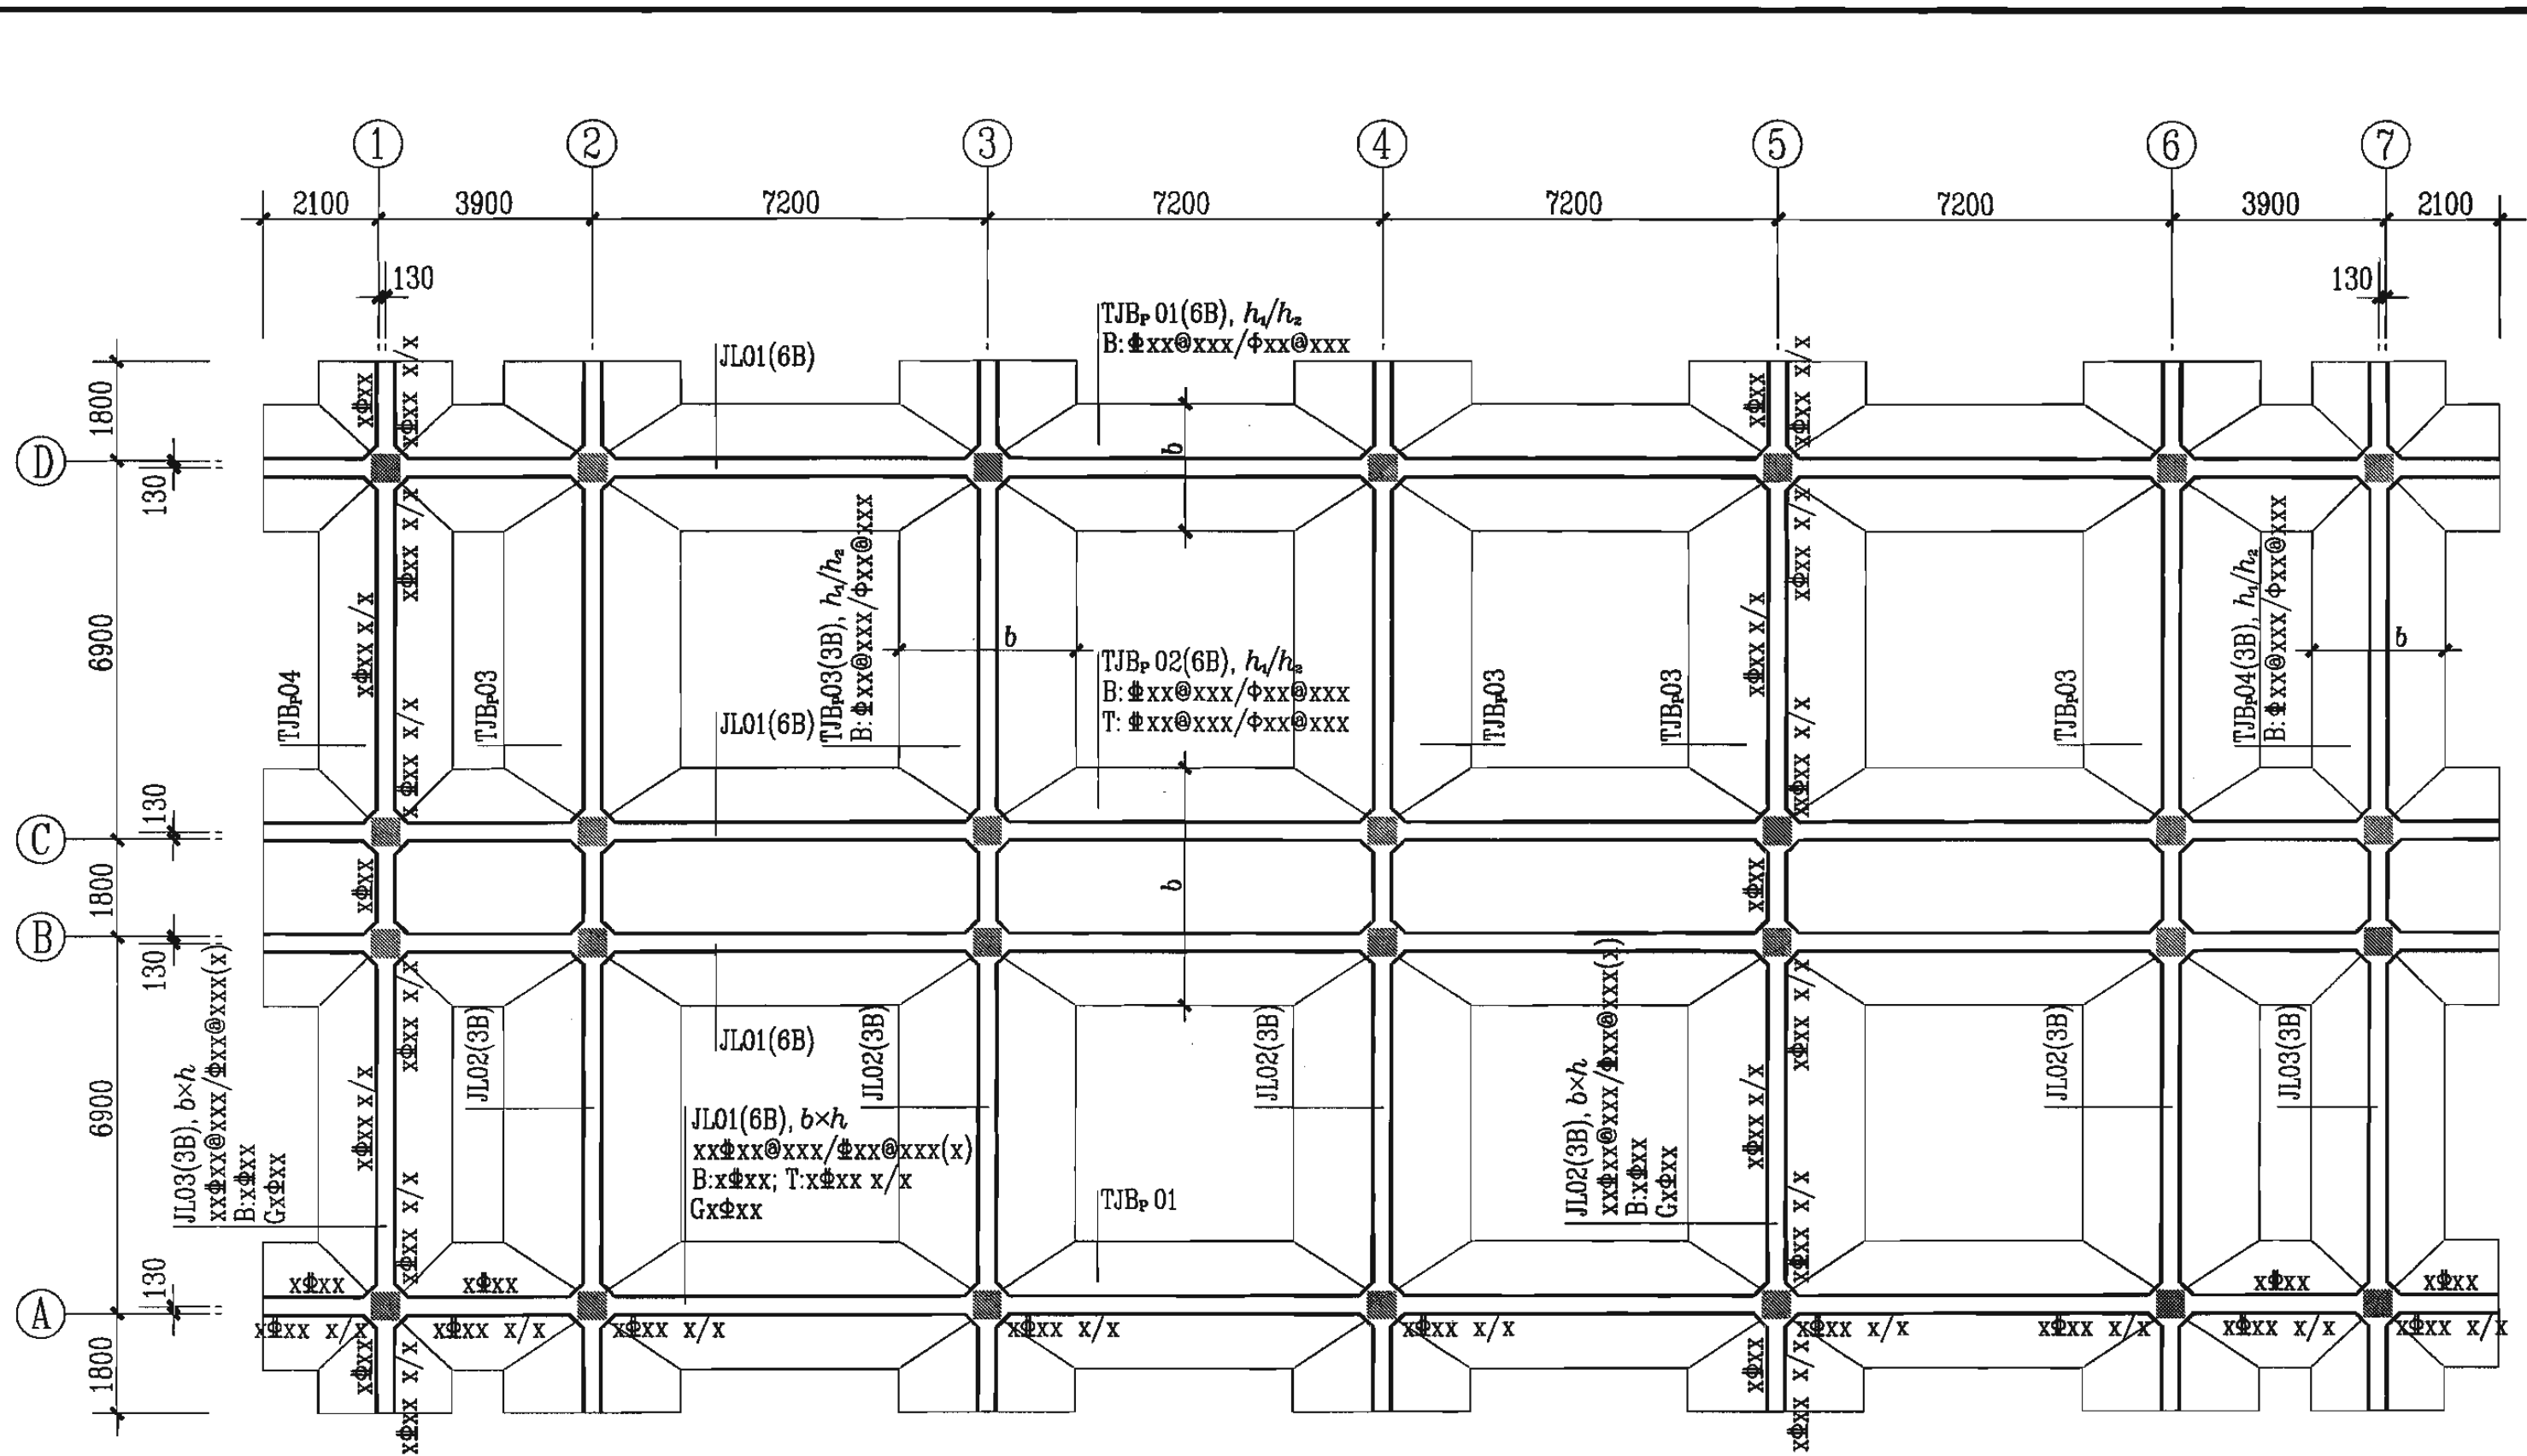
采用平面注写方式表达的条形基础设计施工图示意
